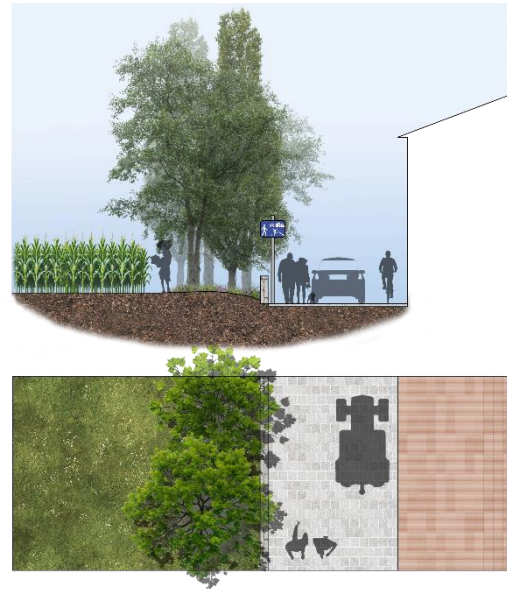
Vista em Perfil e Planta das Ruas Partilhadas | Autor
